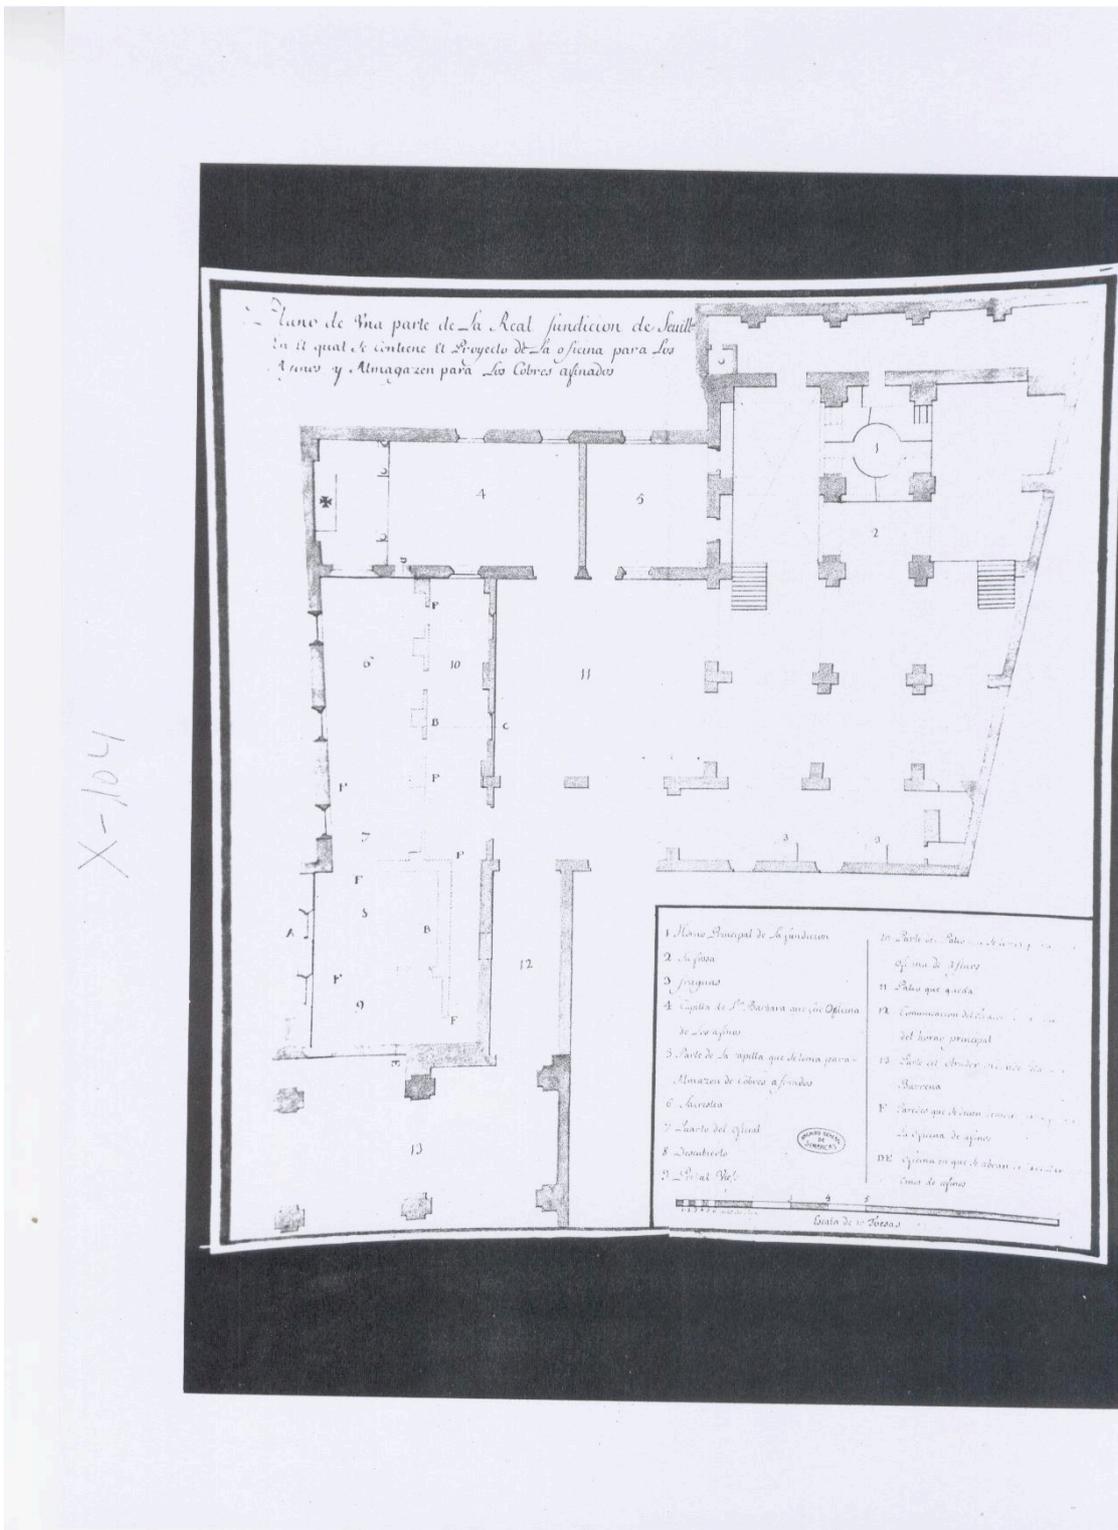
Proyecto de Verboom en 1720 para la planta este de la Fundición. AGS. MP y D, X-104.
